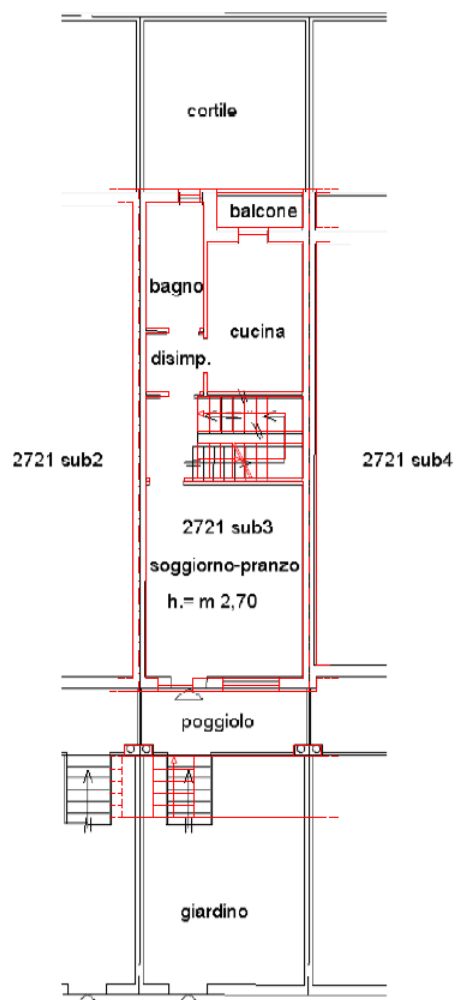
Sovrapposizione rilievo con planimetria catastale in atti (fuori scala). Piano terra
